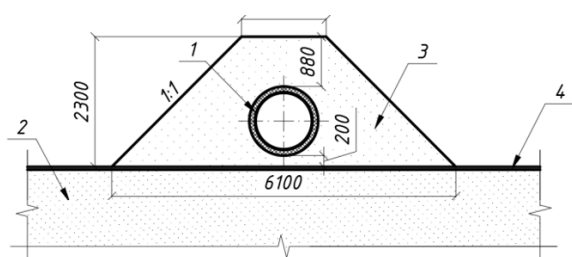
Схема наземной прокладки трубопровода в песчаном мёрзлом грунте: 1 – тело трубопровода; 2 – песчаный грунт основания; 3 – песчаный привозной грунт насыпи; 4 – моховый слой
